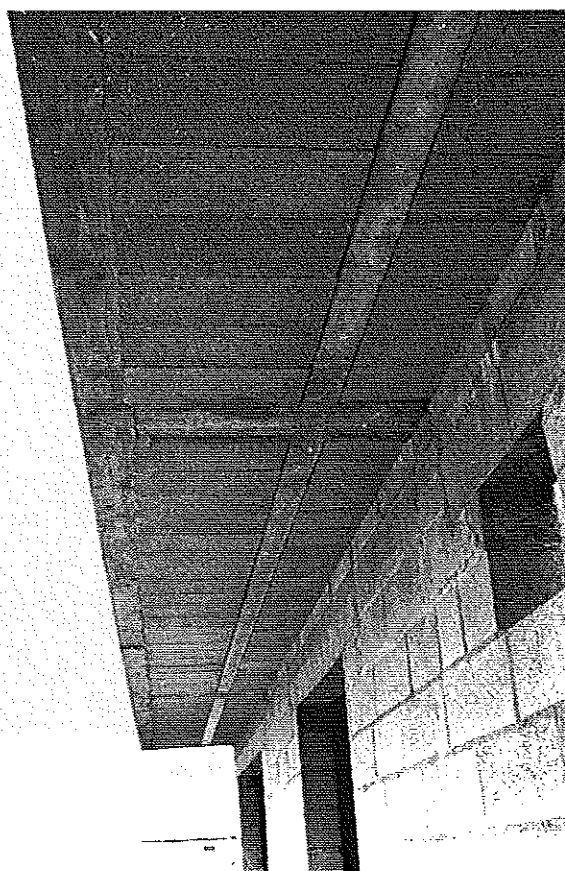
Débord de l'étage. Détail sous-face du plancher. Noter la bande pleine console perpendiculaire à la façade ainsi que la poutrelle préfabriquée et la poutre de rive parallèles à la façade. © J. Putatti
